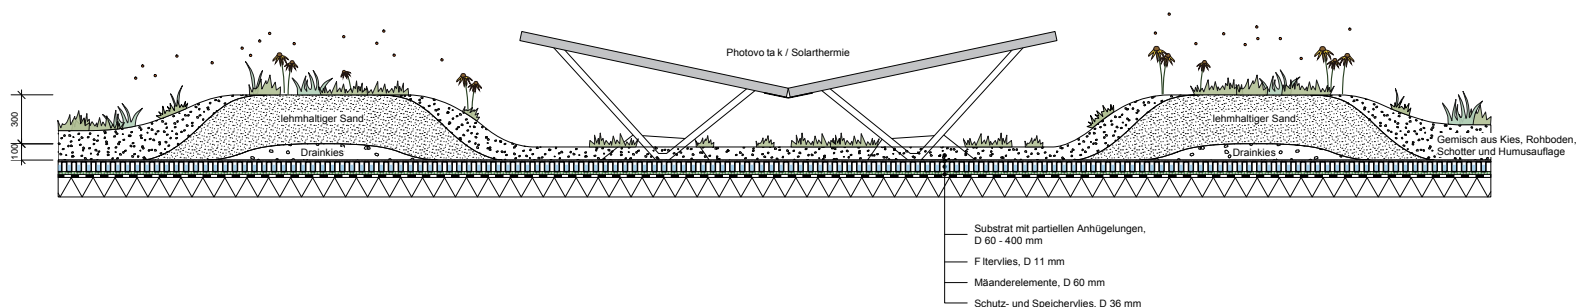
Schematischer Schnitt Dachbegrünung Typ 3: mit Solaranlagen
